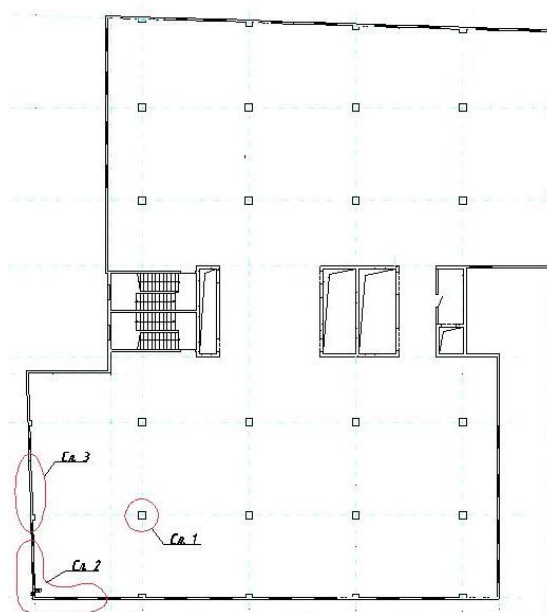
Схема расположения локальных разрушений типового этажа монолитного здания
